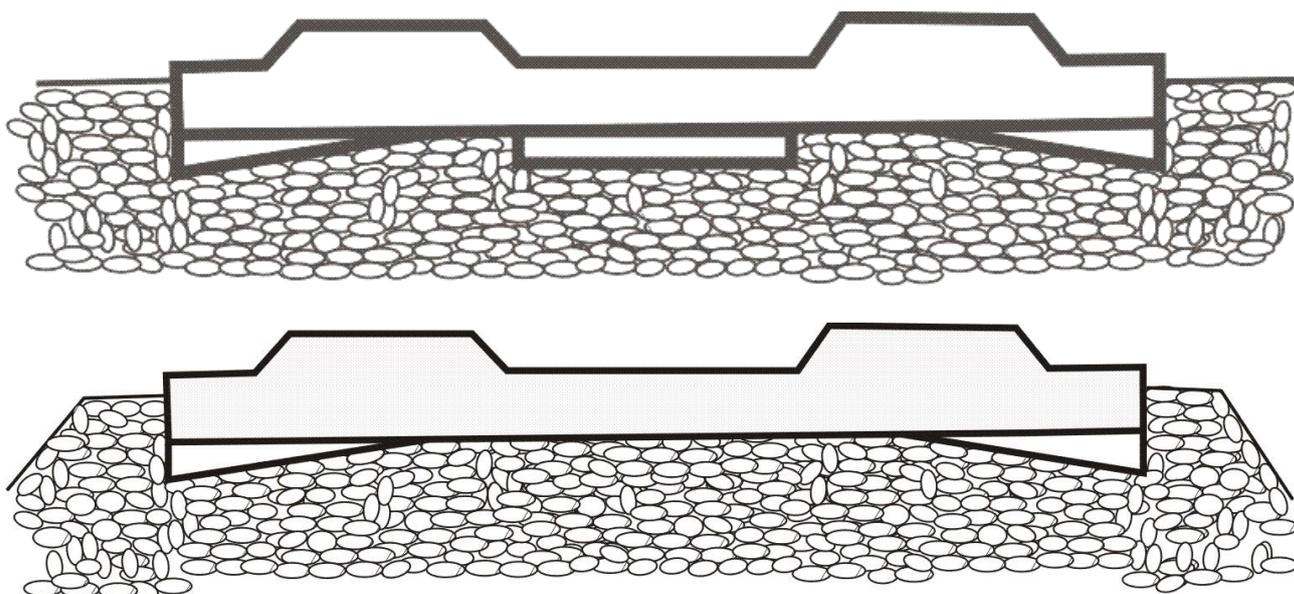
Прогибы железобетонных шпал под нагрузкой
